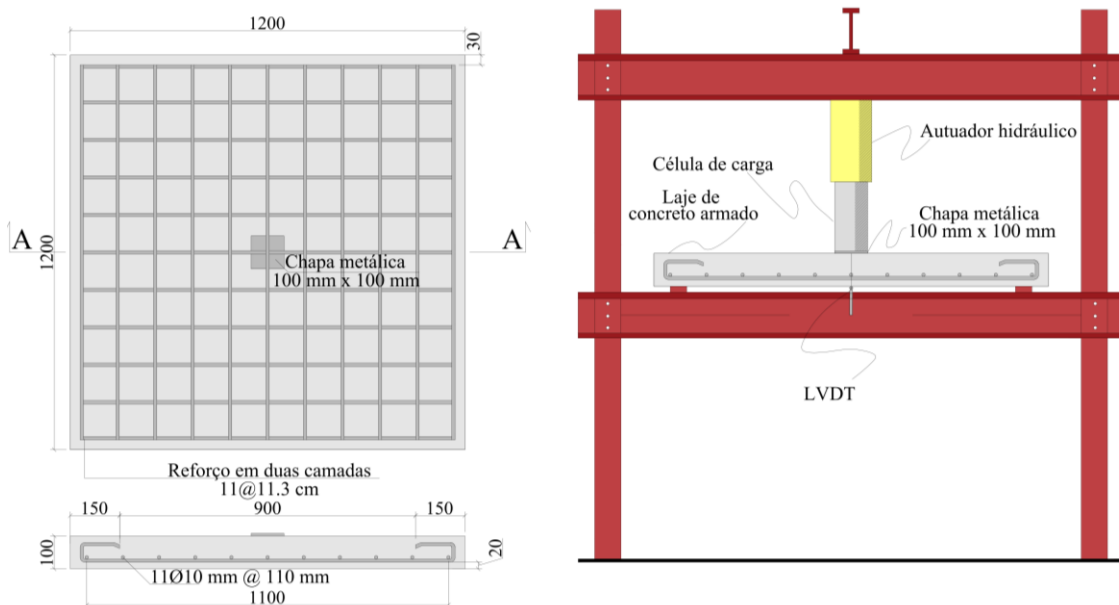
Características das lajes e sistema de ensaio (adaptado de Mahmoud *et al.*, 2018).
